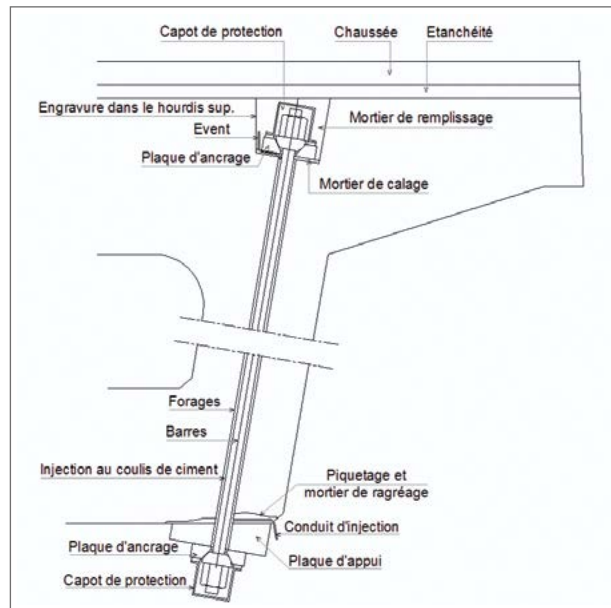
Précontrainte transversale additionnelle à l'intérieur du béton Ancre intérieure au béton (en haut) et extérieure au béton (en bas)
